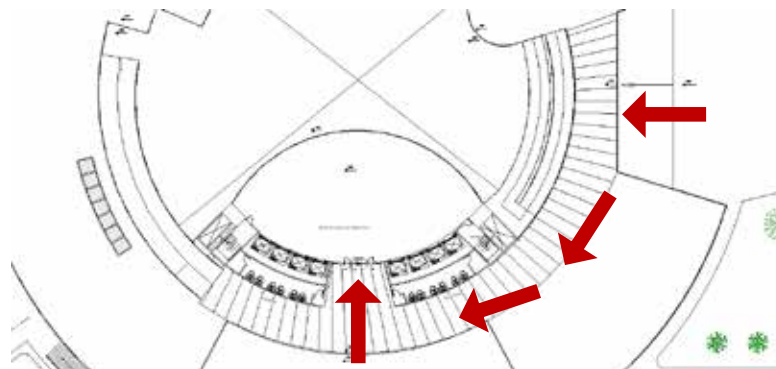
Plano de señalización de acceso de servicio.* Fuente: Plano Planta Baja (2019)
